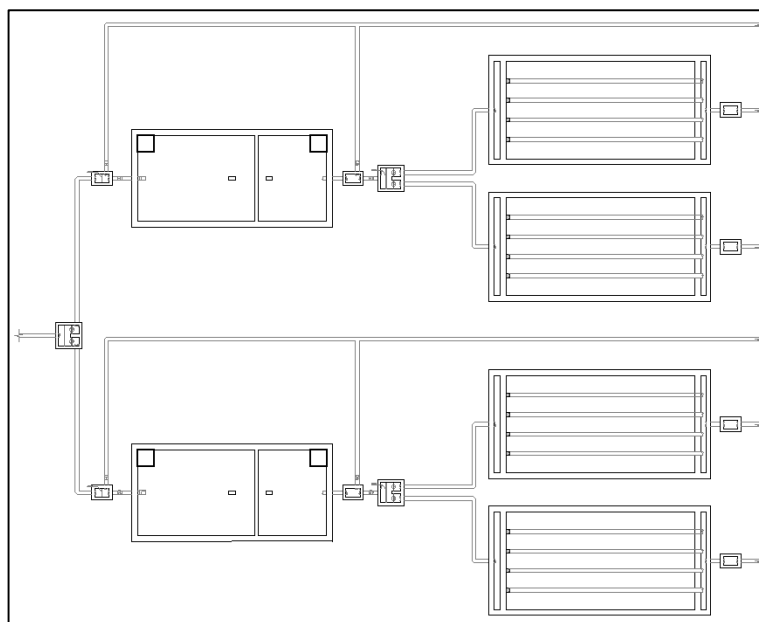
Esquema de la planta de tratamiento según el período de diseño.
